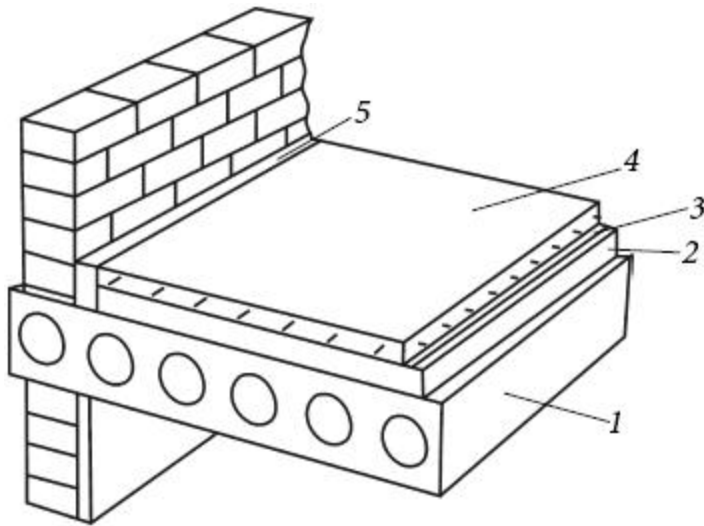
«Плавающая» изоляция на основе экструдированного пенополистирола (ЭППС) по бетонному перекрытию: 1) плита перекрытия; 2) плиты ЭППС; 3) слой гидроизоляции; 4) стяжка с армированием; 5) заполнение зазора между полом и стеной
